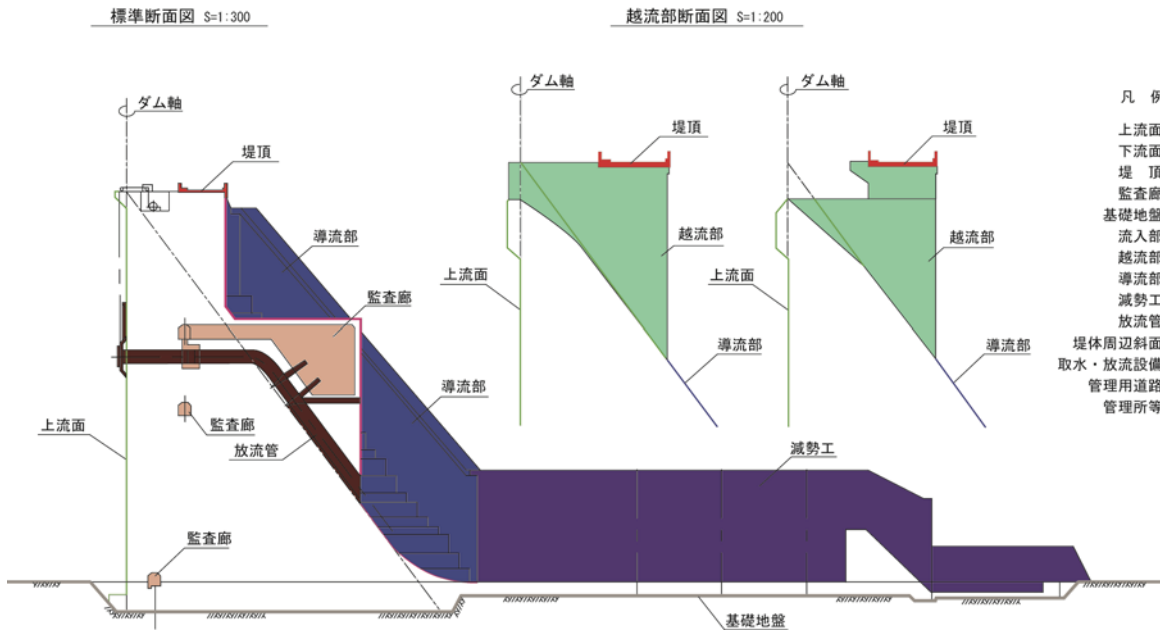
重力式コンクリートダムの構成要素（断面図）
